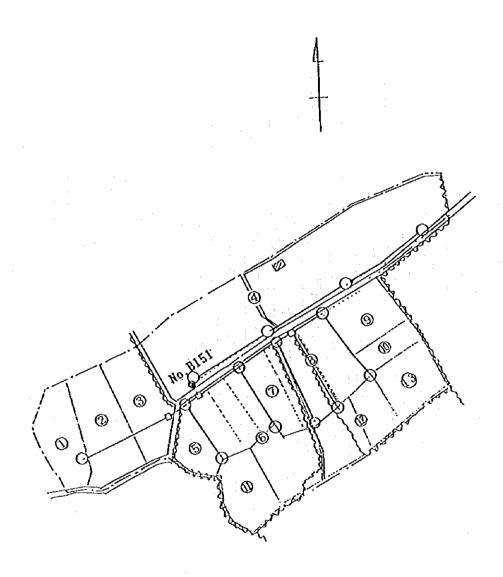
Plan horizontal du projet des installations terminales (Limaoua)
